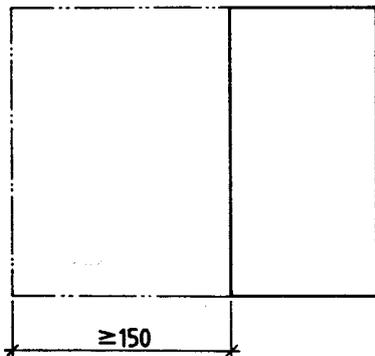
Bewegungsfläche vor einer Längsseite des Bettes des Rollstuhlbenutzers
